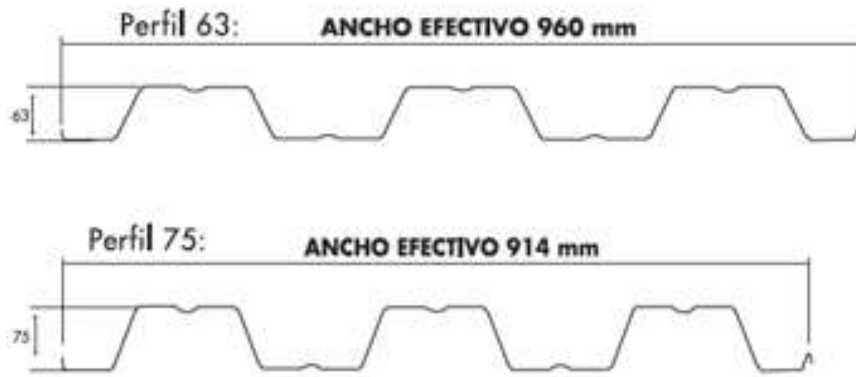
Perfiles de lamina losacero disponibles en nuestro medio
